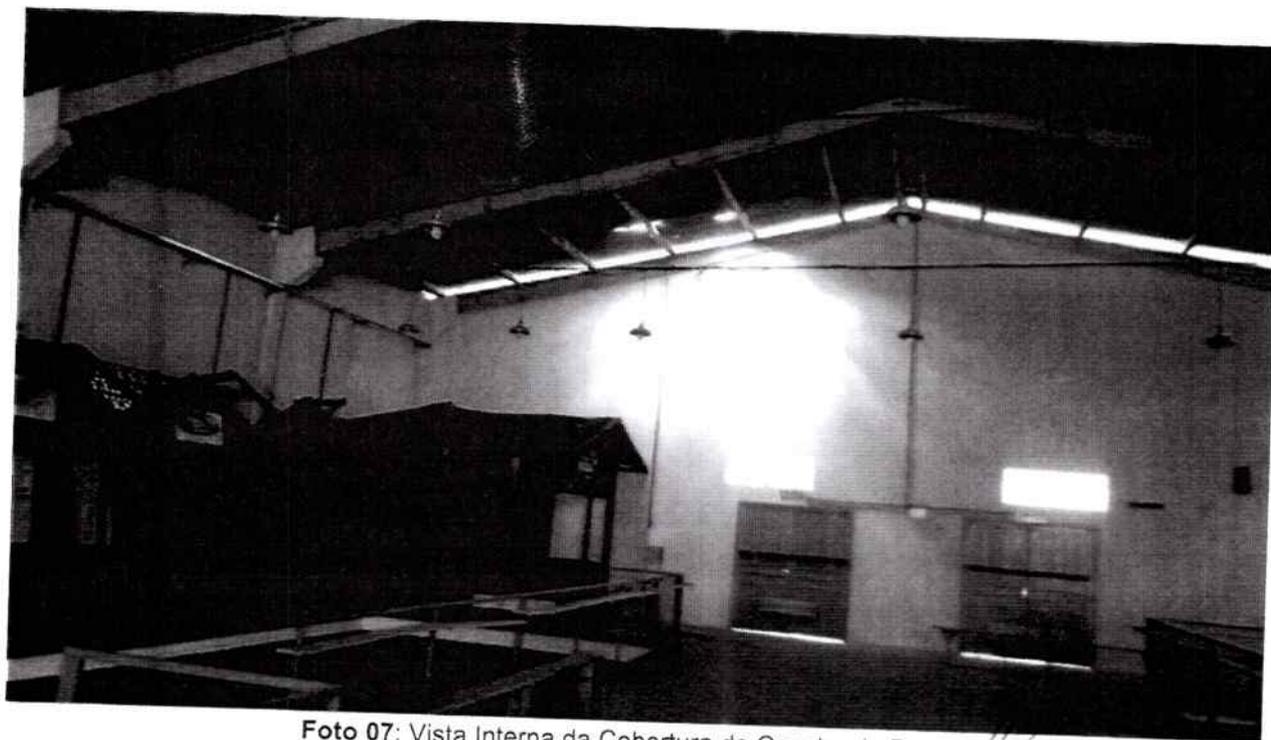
Vista Interna da Cobertura da Cancha de Bocha
